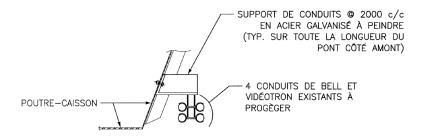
Conduits de Bell et Vidéotron, extrait des plans de réfection de SNC-Lavalin 2010-04-23
